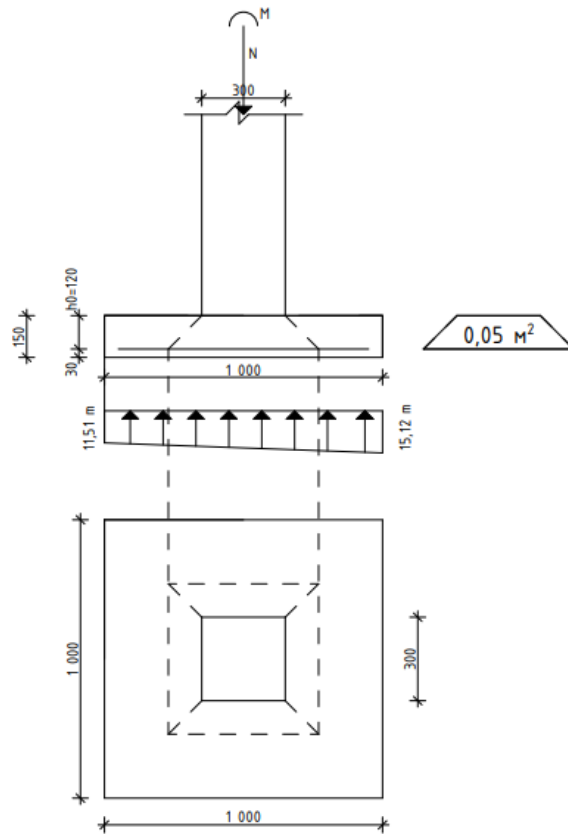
Расчетная схема расчета фундаментов на продавливание
